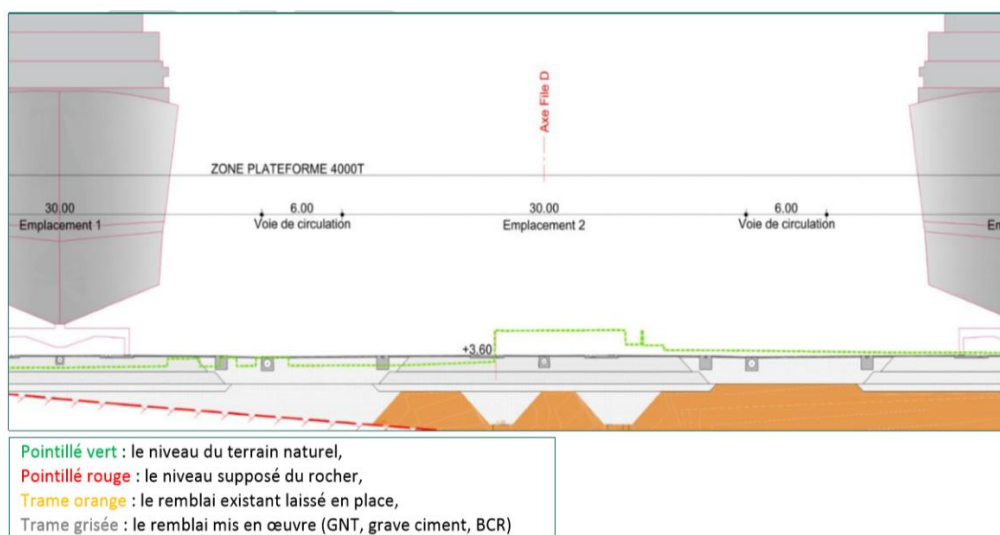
Extrait profil en travers de la plateforme (source plan AVP-TEF-115-C) et localisation des terrassements de la plateforme
